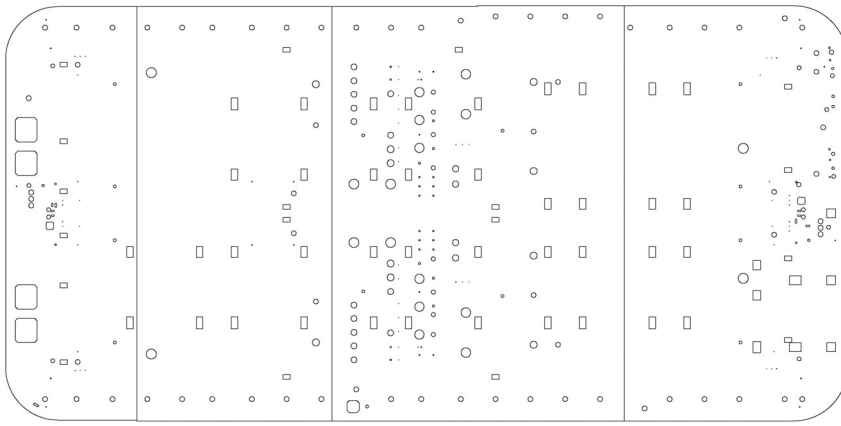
Planta de la estructura con situación general de embebidos, pasatubos y bocas de acceso en la losa superior.
